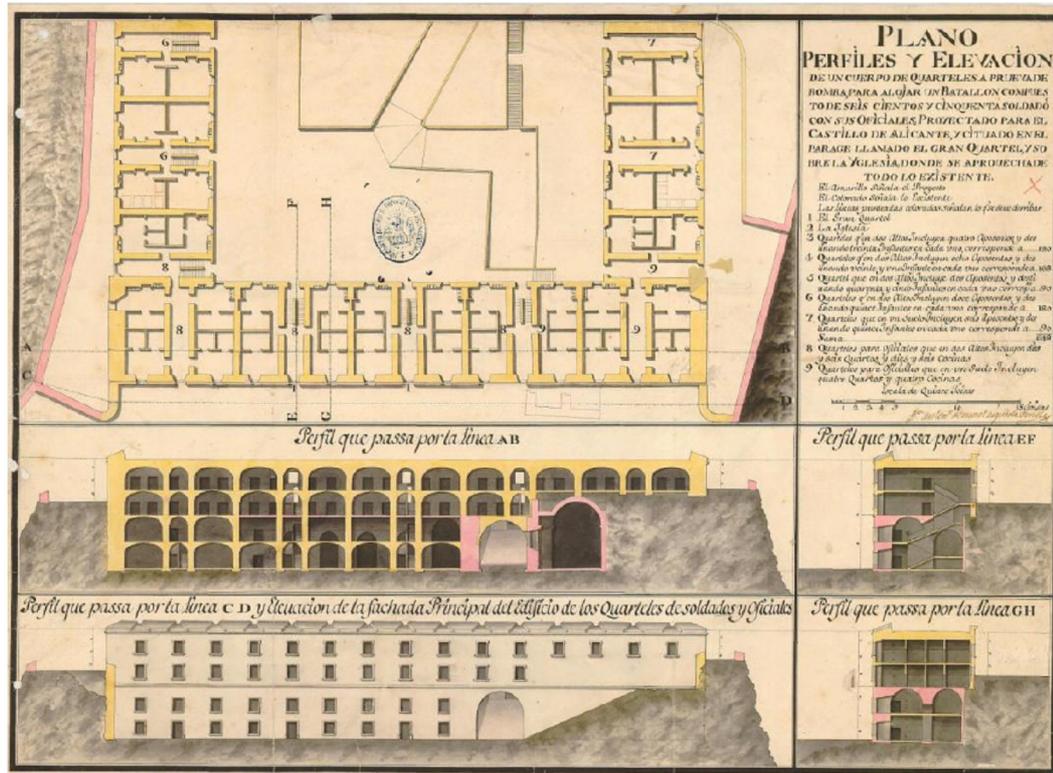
“Plano del castillo de Alicante con el proyecto de algunas obras”. Antonio Montaigut. IHCM. Plano A-02-08.
